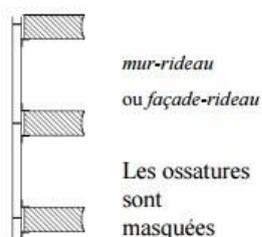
Mur rideau ou façade rideau _ Source : CERTU
